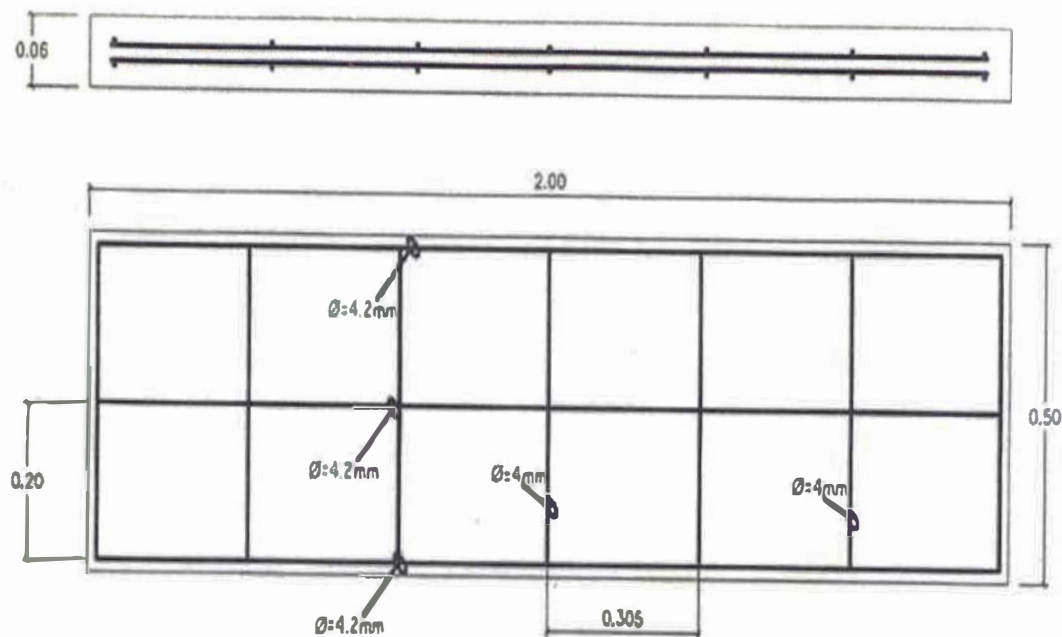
Dimensionamiento de varillas de acero en los paneles
